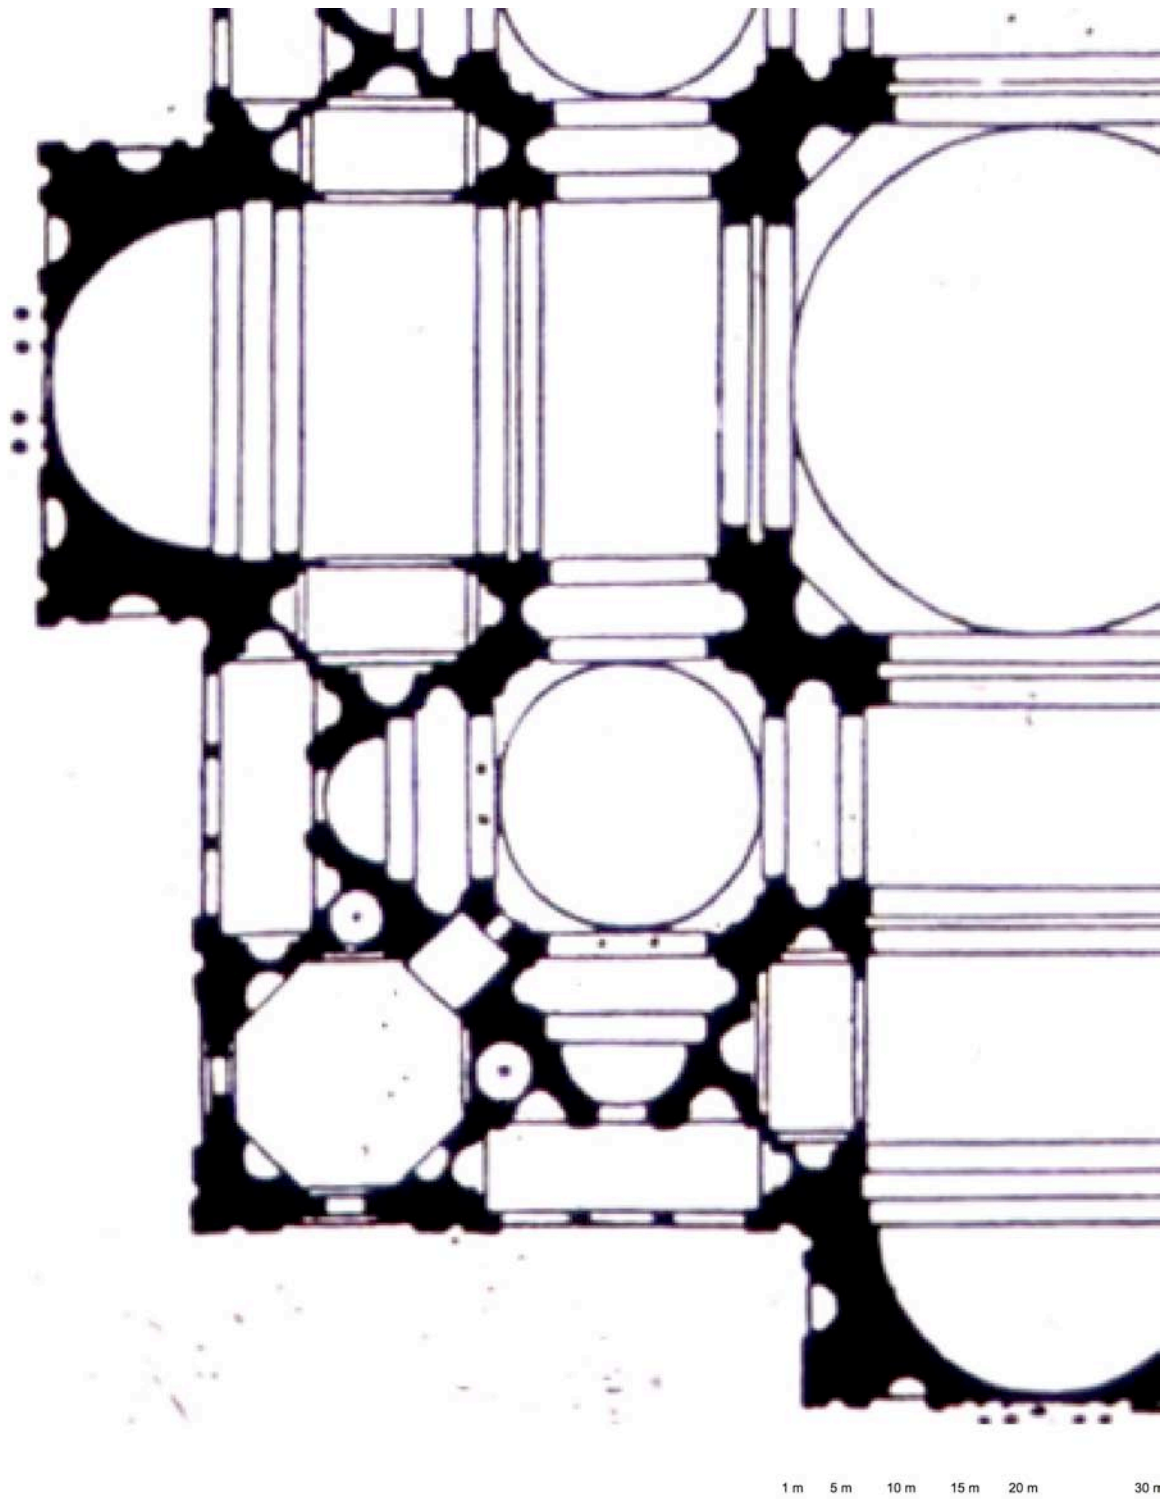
Arquitecturas centralizadas a la misma escala de las imágenes anteriores y la posterior. San Pietro in Vaticano, 1506-1514, la primera versión diseñada por Bramante.
